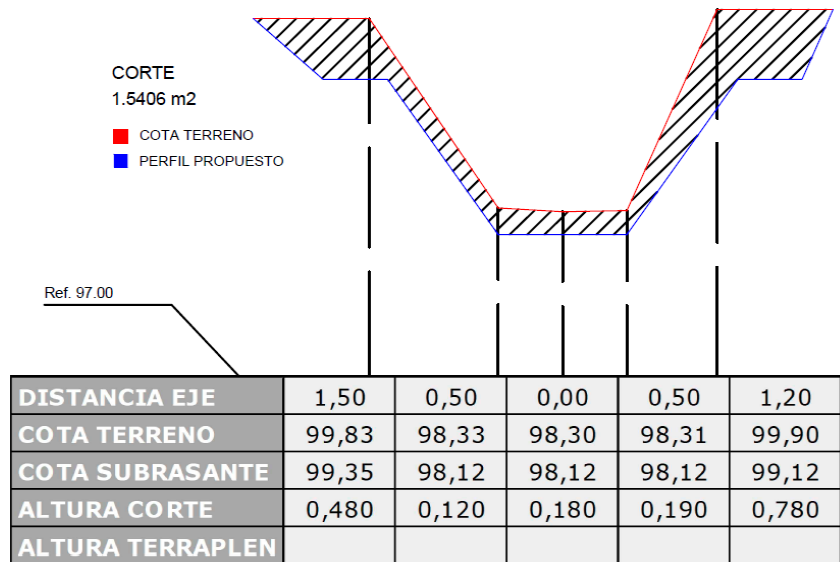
Perfil Transversal N°1 (Fuente Propia)
